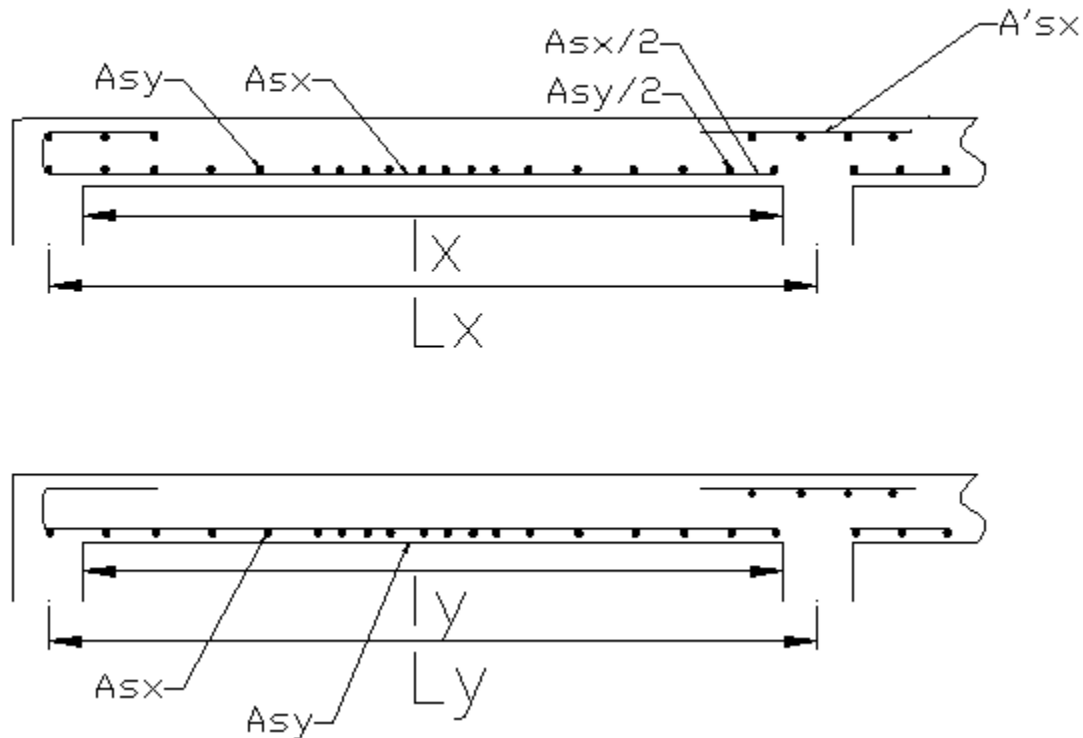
FERRAILLAGE D'UNE DALLE PLEINE
